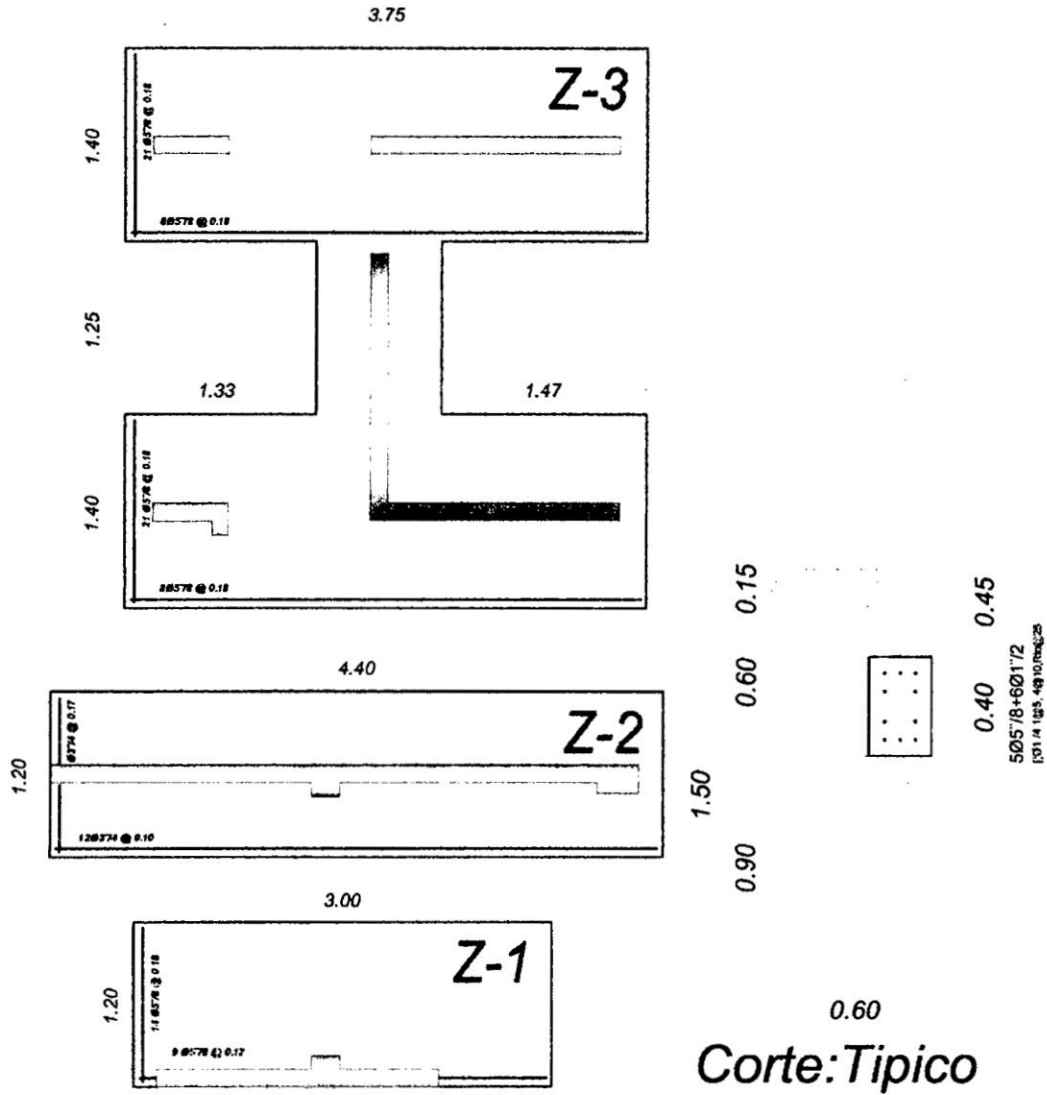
Armado de las Zapatas de los muros de concreto armado
